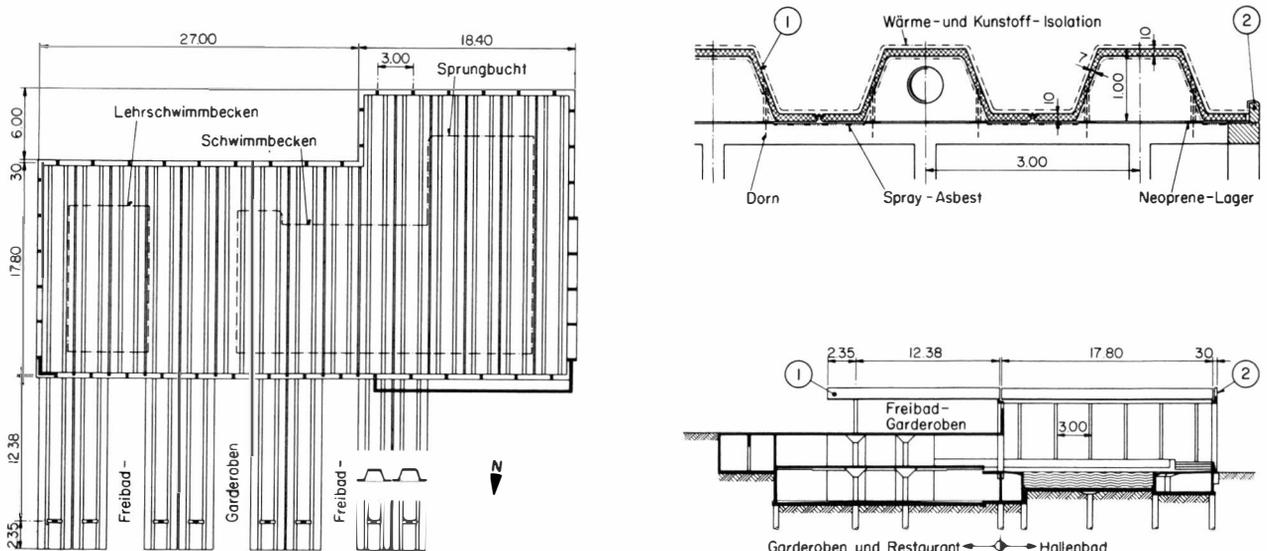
Grundriss, Querschnitt, Detailschnitt Faltwerke. 1 Faltwerkelement, 2 Ortbetonrand
